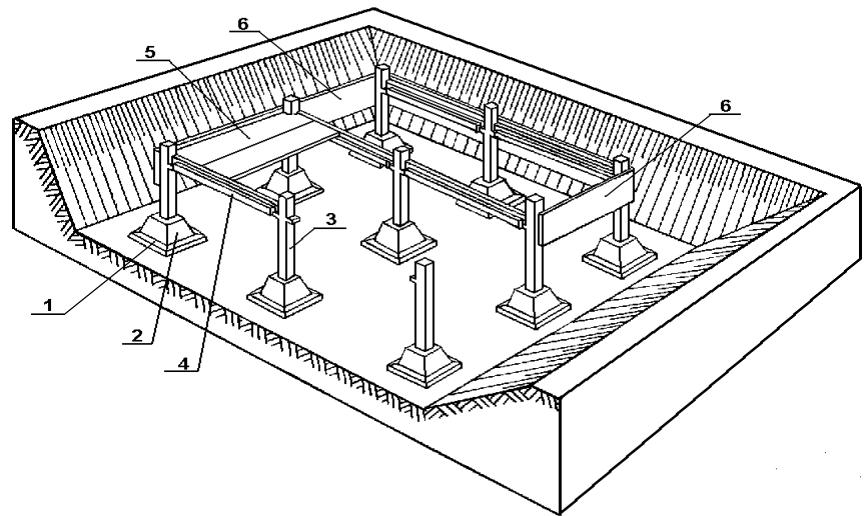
Отдельностоящие фундаменты под каркас здания.
